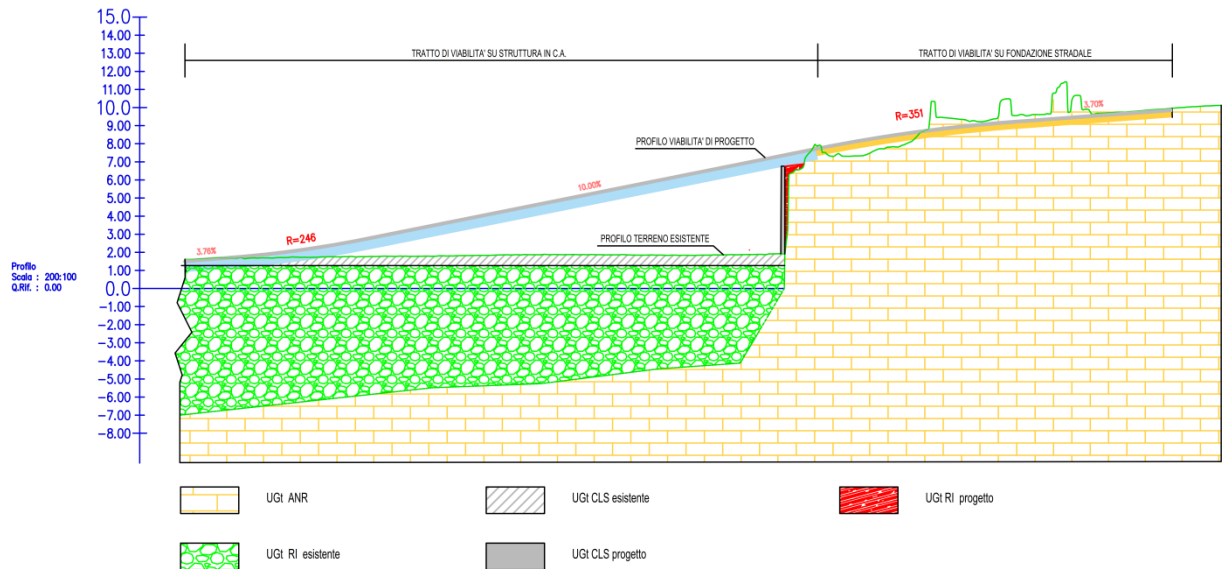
Sezione geotecnica schematica dell'area in cui è prevista la realizzazione della rampa di accesso.
